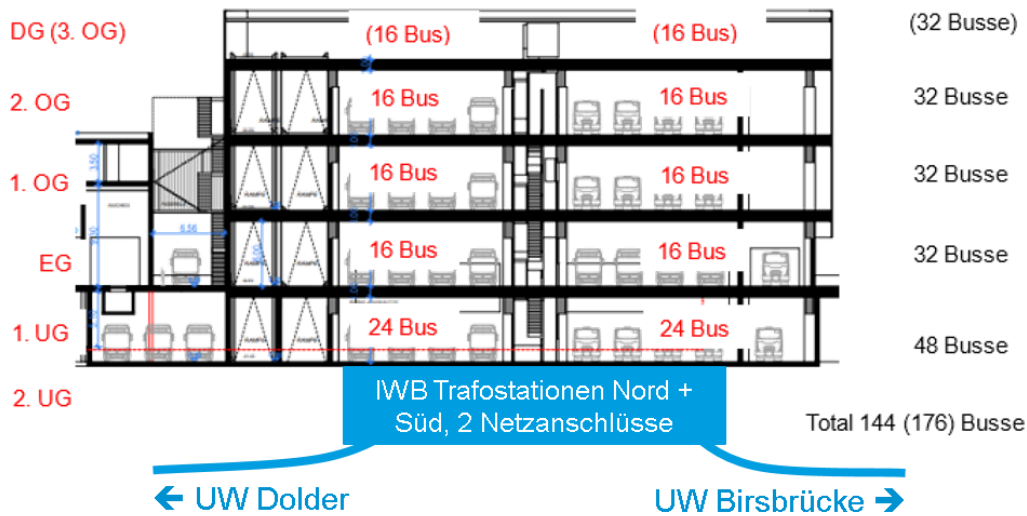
Layout zukünftige Garage Rank (Schnitt Gebäude)
